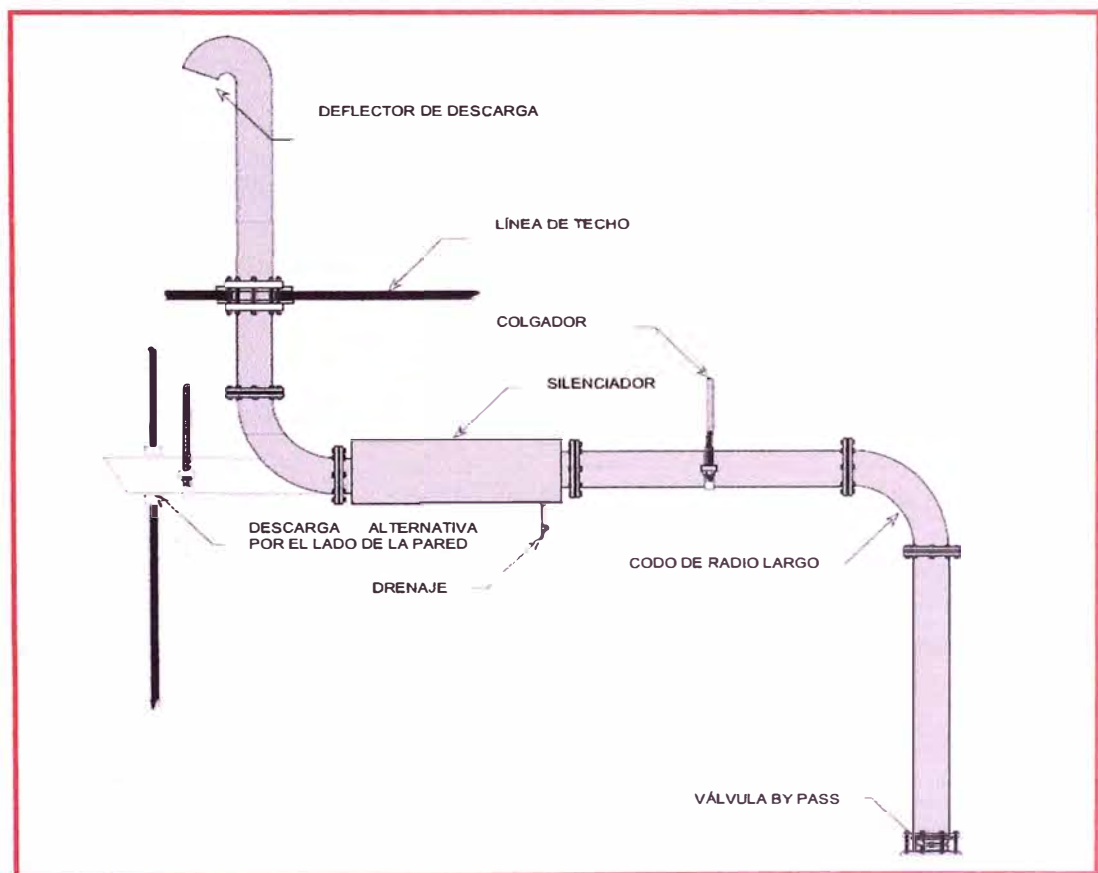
DISPOSICIÓN DE TUBERÍA BY PASS
